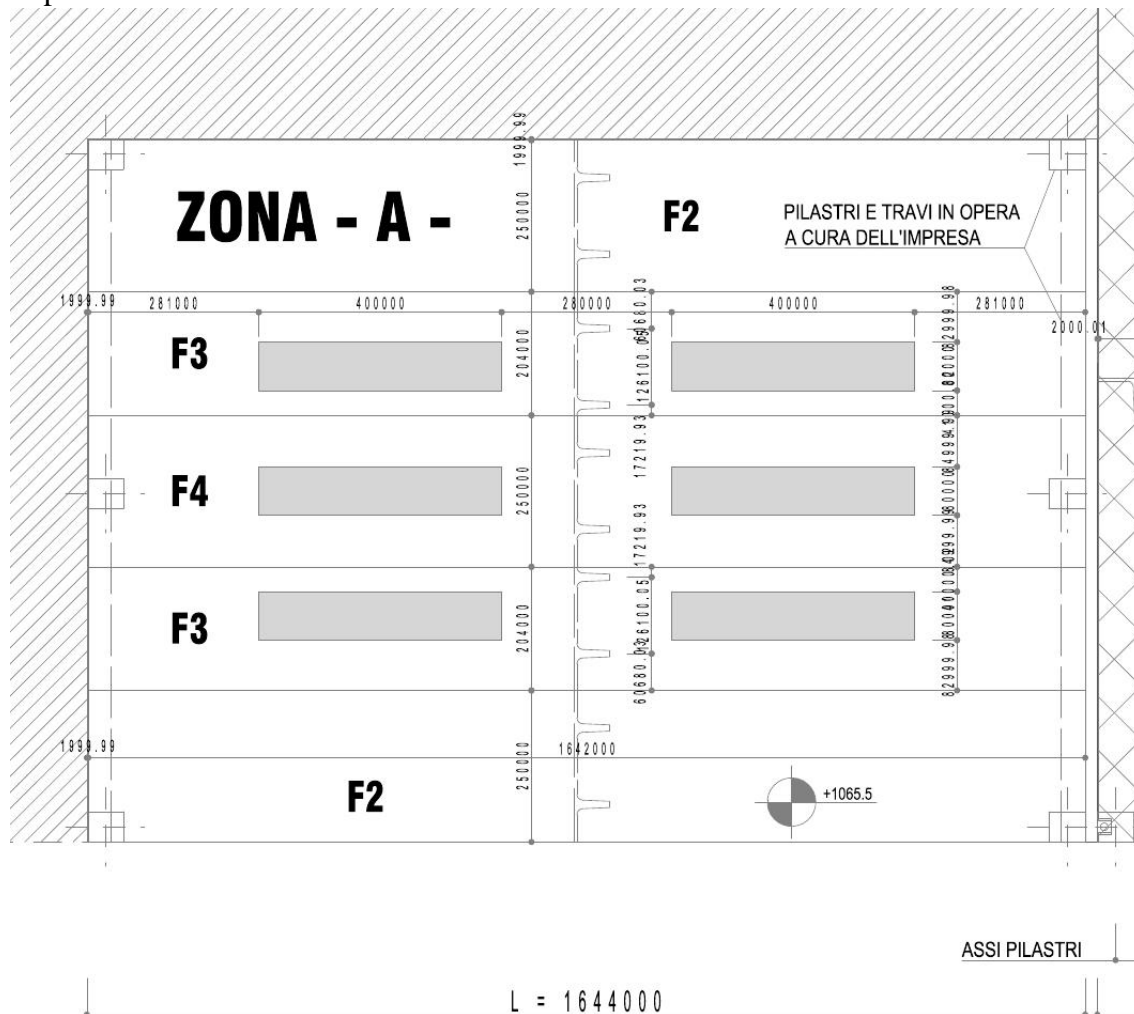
Particolare di A.2003.cap.us.T22 - Pianta copertura - Copertura Zona A
